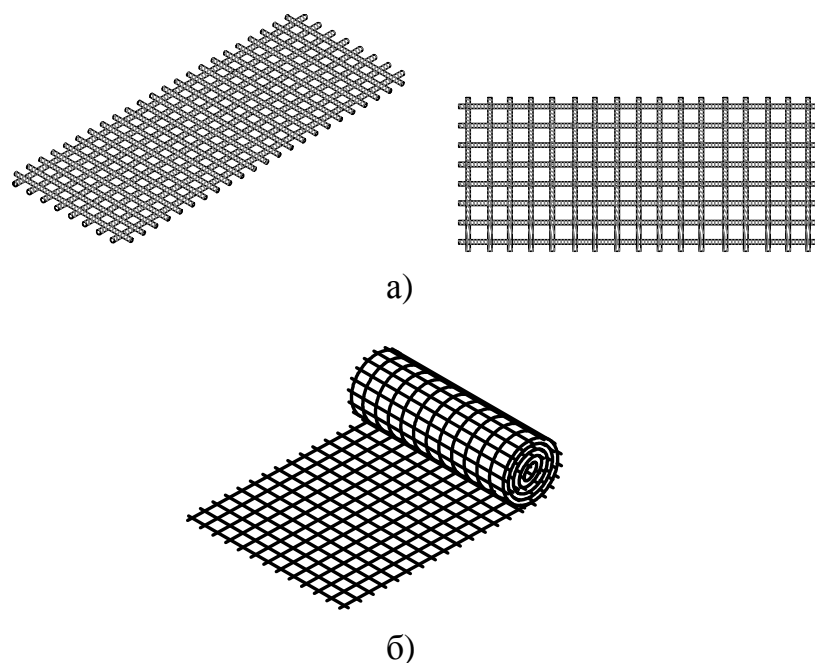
(а, б). Типы сварных сеток:
